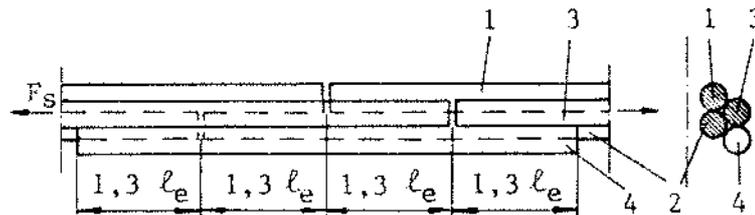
Ejemplo de un empalme traccionado con la adición de una barra a un paquete de tres barras.
